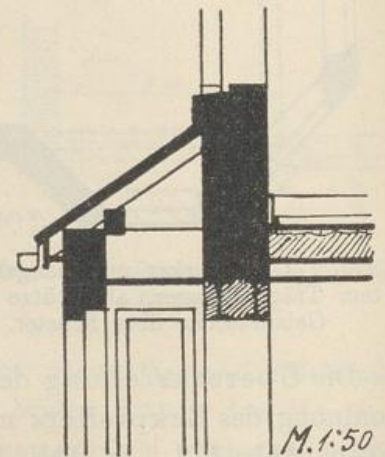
Unzweckmäßige Deckenkonstruktion.
